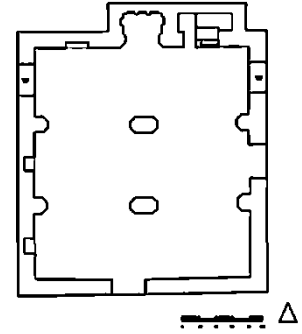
مسقط أفقي لمسجد شالا فتاني /فازا
